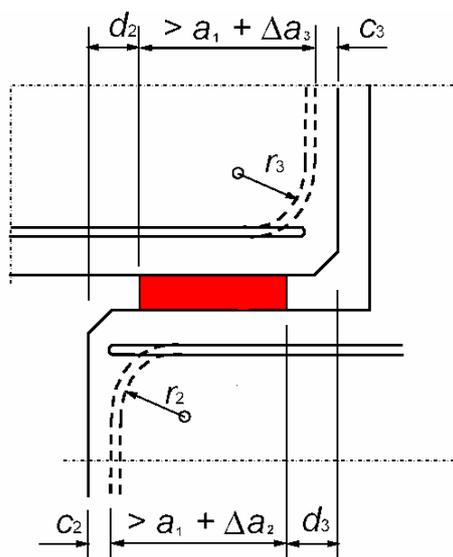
b Ejemplo de detalle de armado en un apoyo
